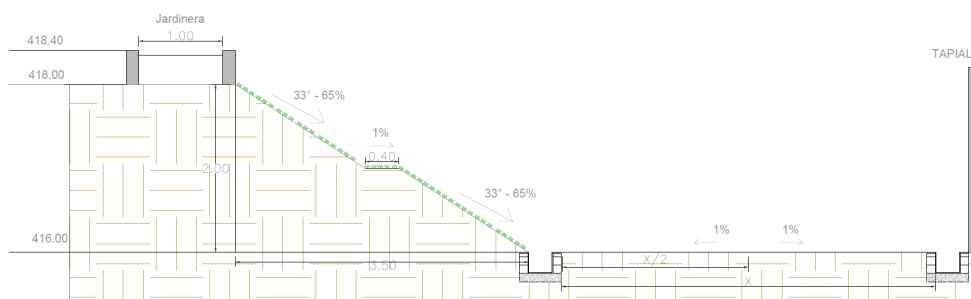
18. Perfil de talud interior y área de tapial perimetral norte.
